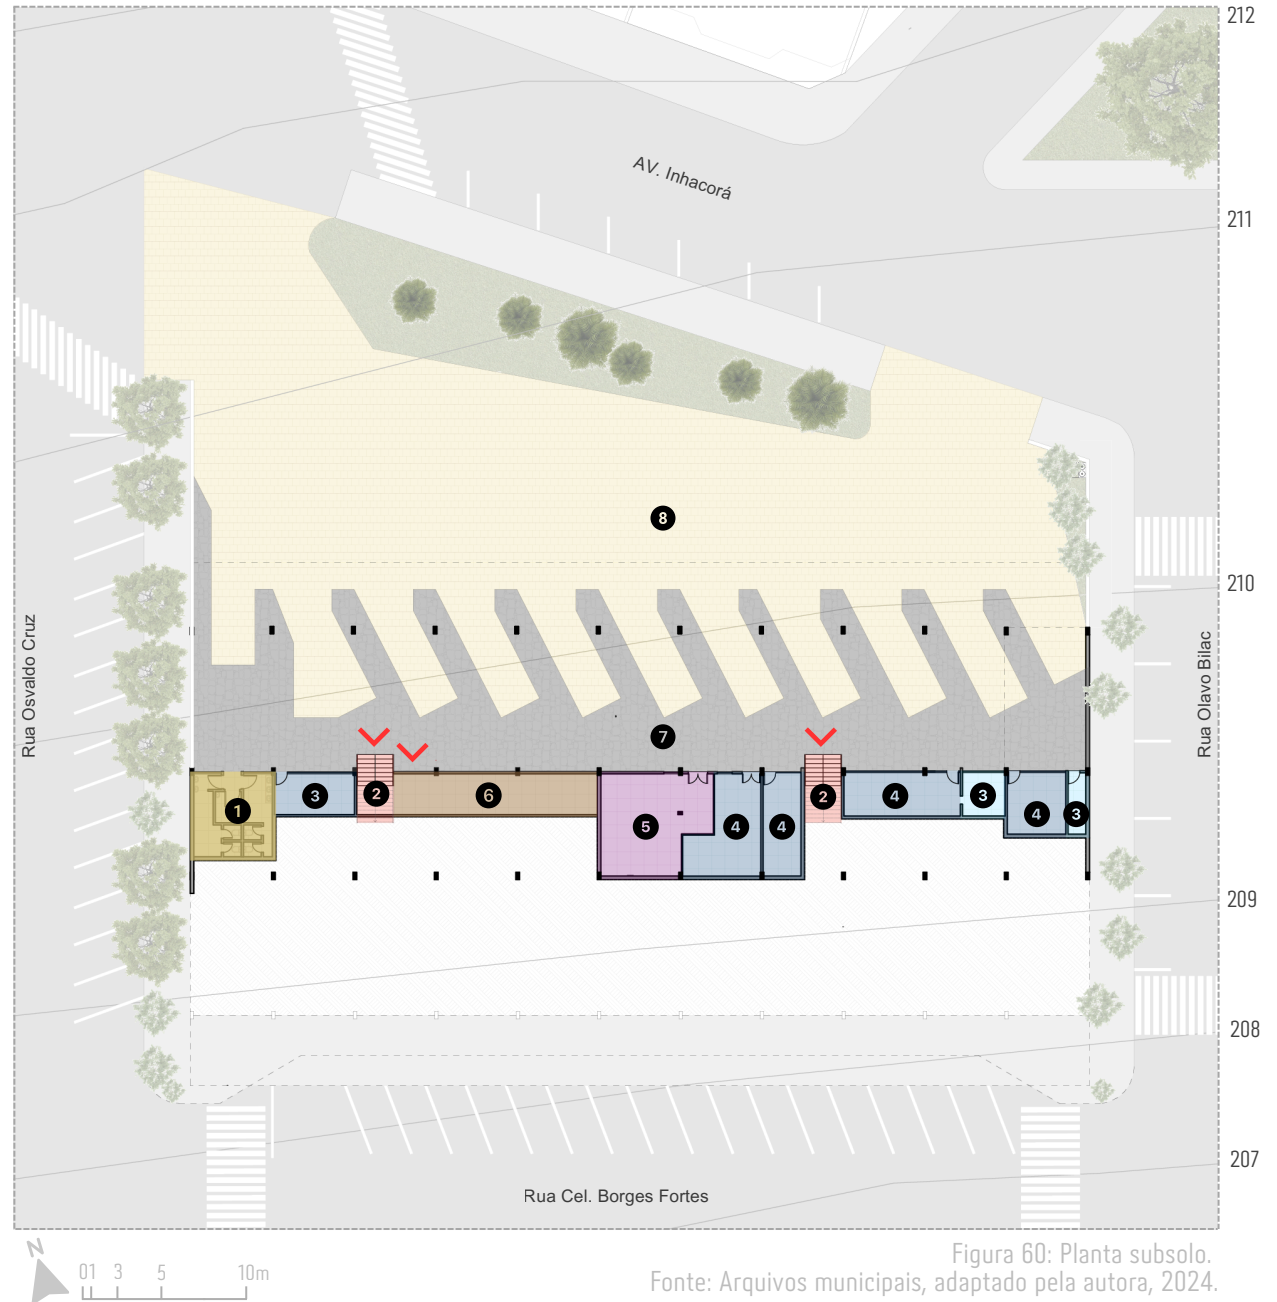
Planta subsolo. Fonte: Arquivos municipais, adaptado pela autora, 2024.
